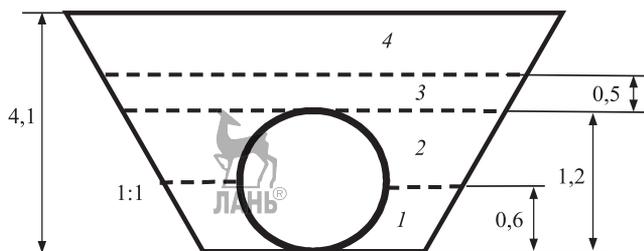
Схема засыпки котлована после укладки звеньев:
